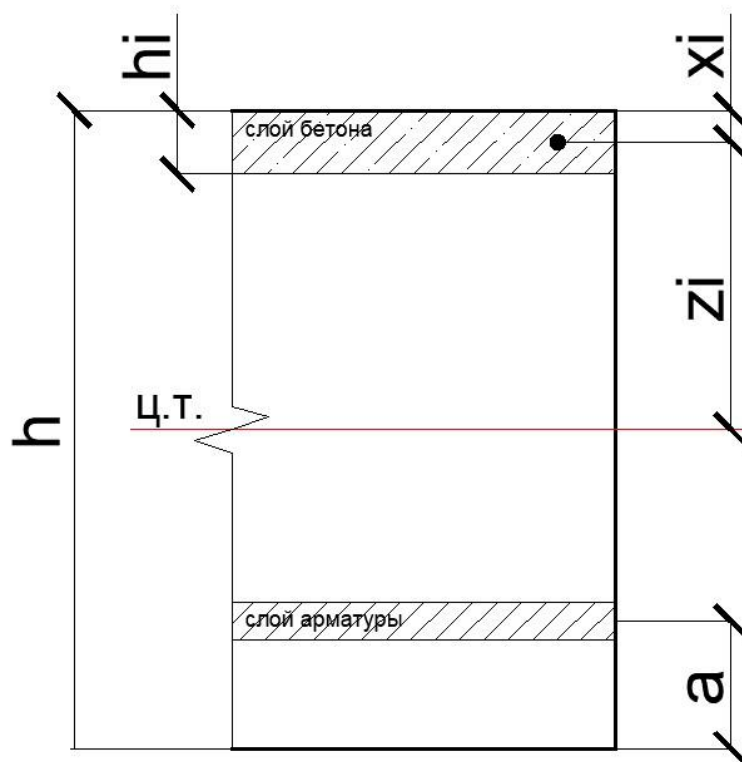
Пояснения к нахождению значений z_i для слоёв бетона и арматуры.
